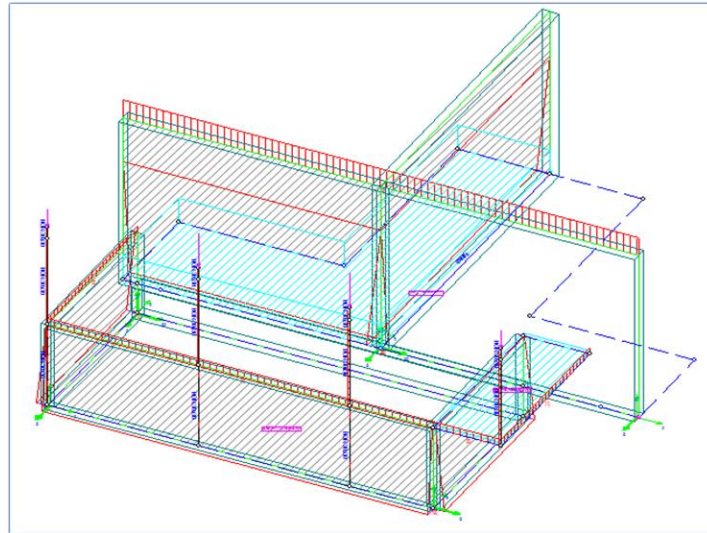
Ejemplo de modelo para el cálculo estructural de sala de válvulas
